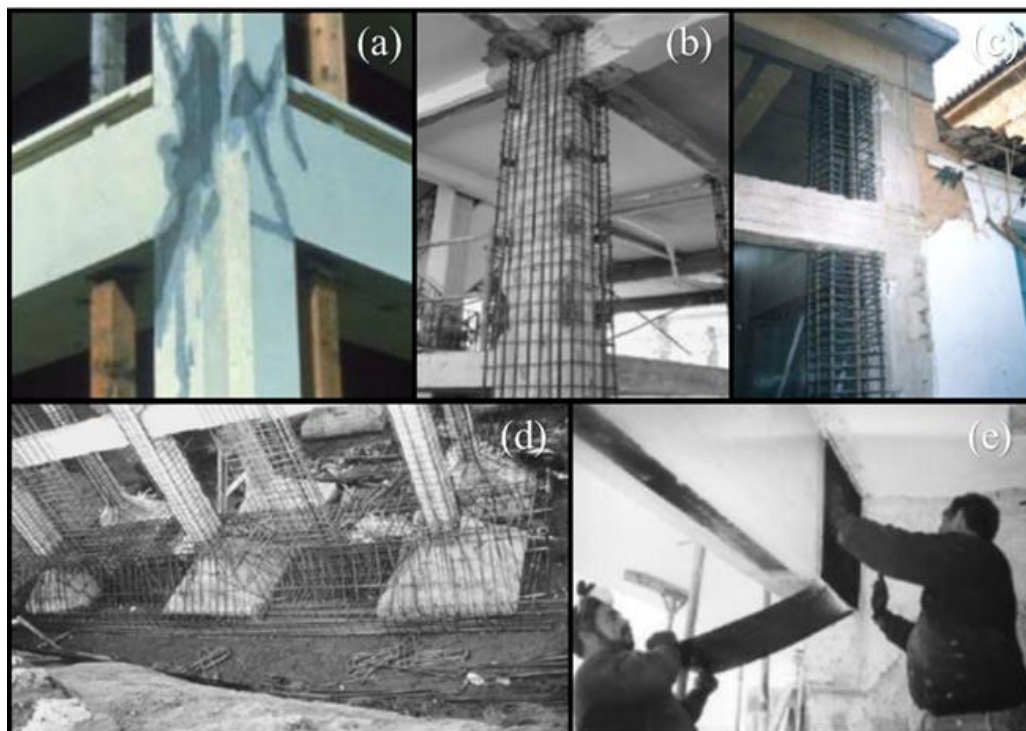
Ejemplos de técnicas de retrofit. a) reparación estructural del mortero; b) reforzamiento del hormigón armado con encamisado en la columna central; c) elemento de hormigón armado adicional a la columna existente; d) mejoramiento de la fundación y muro adicional al marco existente; e) reforzamiento con láminas de fibra de carbono (CFRP) [3]
